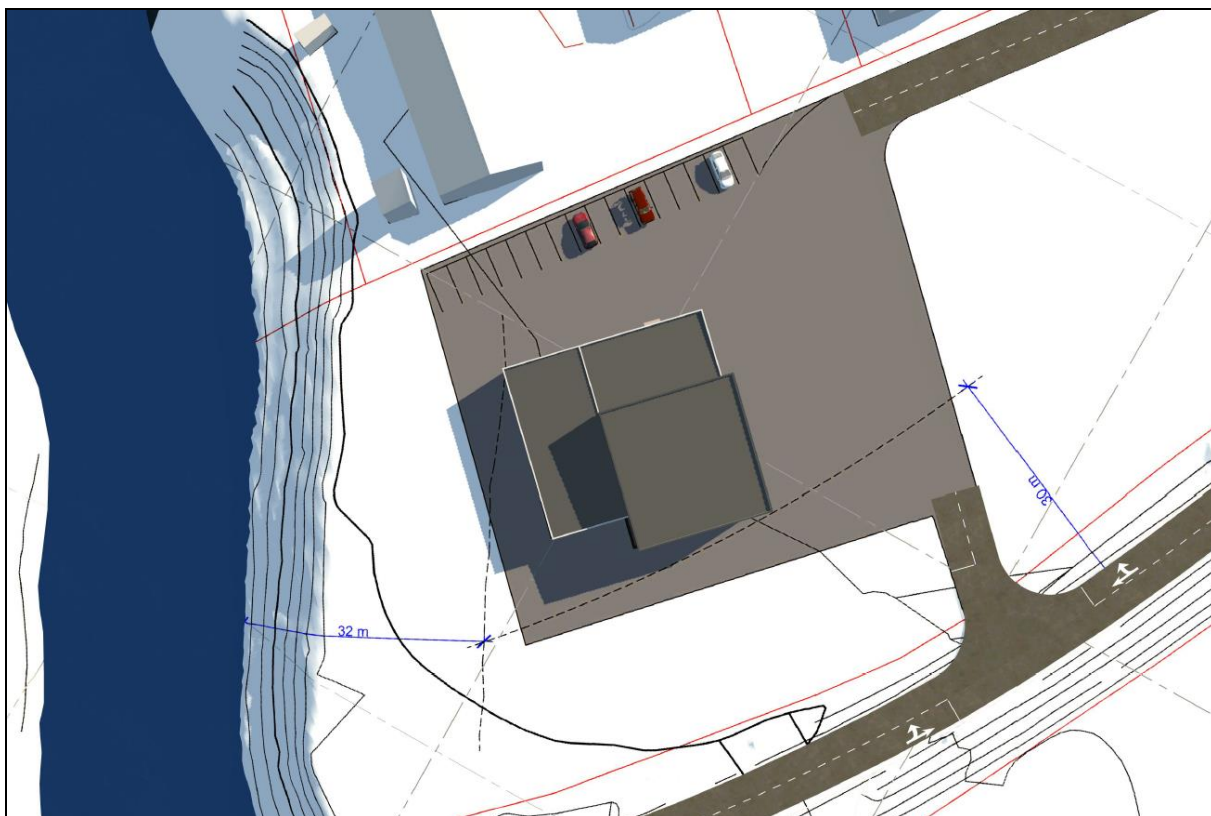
Situasjonsplan (© HD plan & arkitektur AS).
